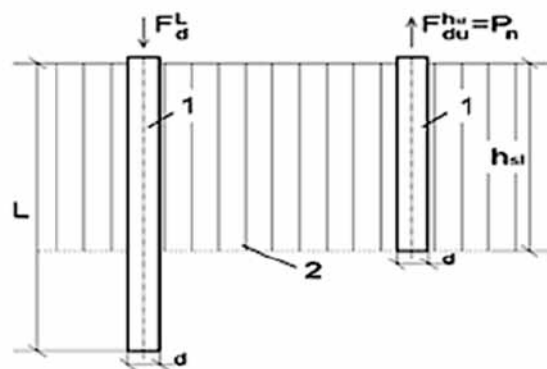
Схема испытаний свай в просадочных грунтах: 1–опытная свая; 2–просадочная толща грунта.
